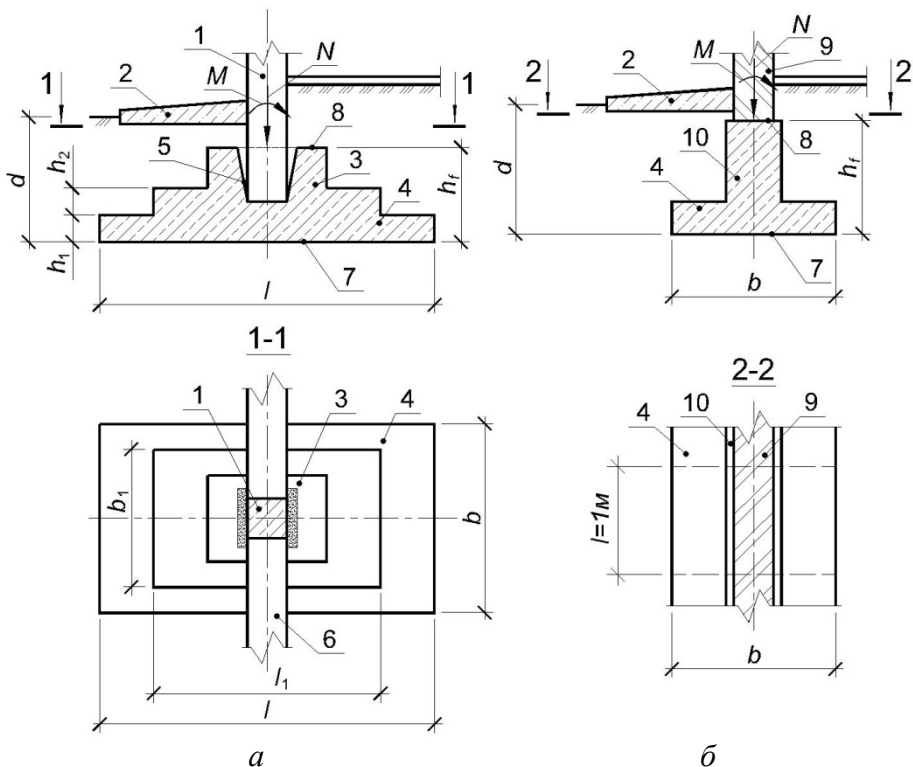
Фундаменты мелкого заложения из монолитного железобетона:
